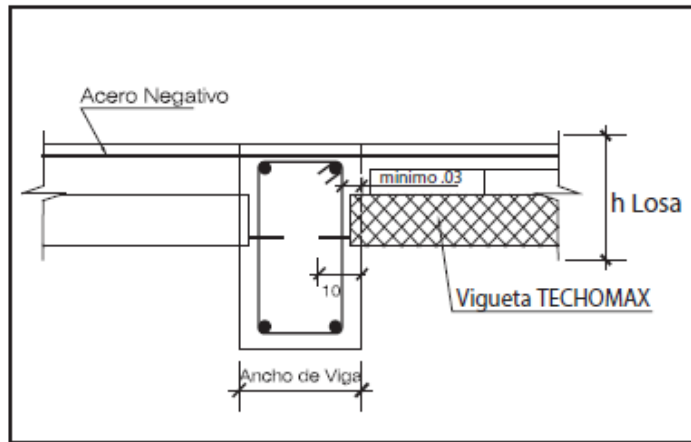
Detalle del anclaje de la vigueta prefabricada tipo Firth en apoyo discontinuo con concentración de acero.
